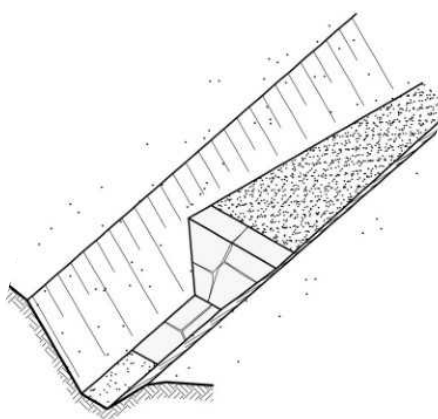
Sección longitudinal y vista en perspectiva de salto en mampostería en cuneta. Fuente: Elaboración propia.
